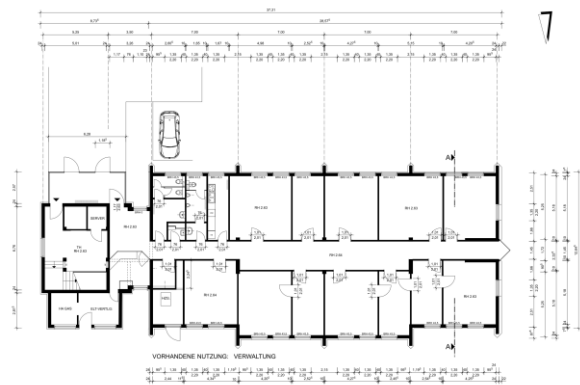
Grundriss EG, bestehendes Hortgebäude, Siegweg 4
